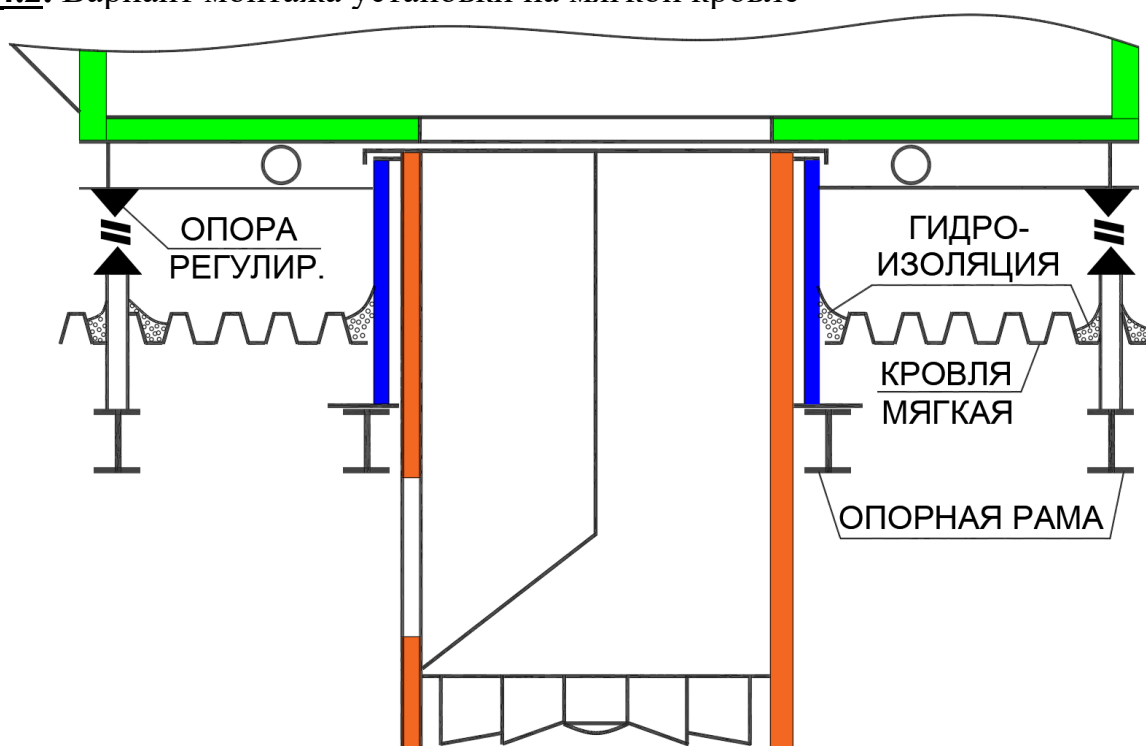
Вариант монтажа установки на мягкой кровле
